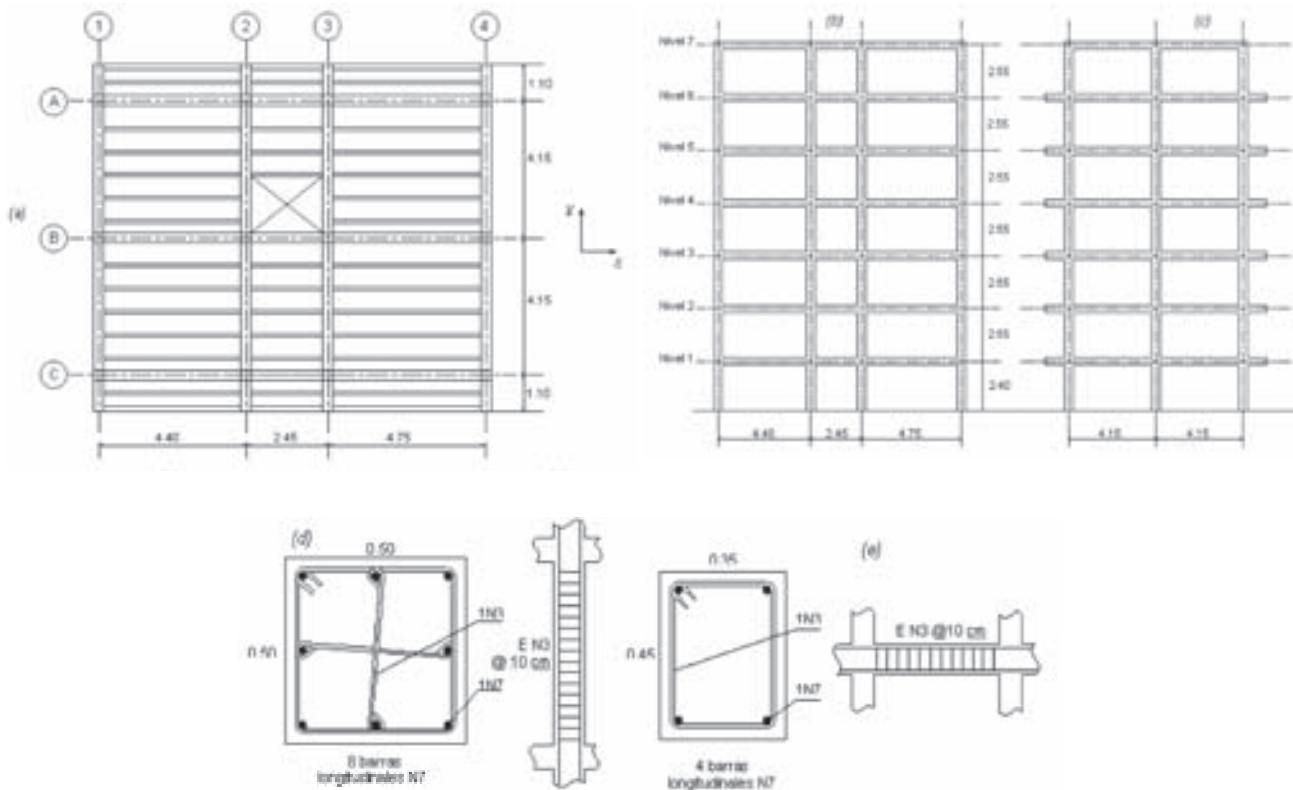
(a) Vista en planta de los pisos 1-6; (b) Pórticos A, B, C; (c) Pórticos 1, 2, 3 y 4; y Refuerzo longitudinal y transversal: (d) columnas y (e) vigas. Todas las medidas en metros
